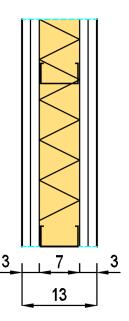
Muro pladur grosor 13 cm. Fuente: Elaboración propia.
